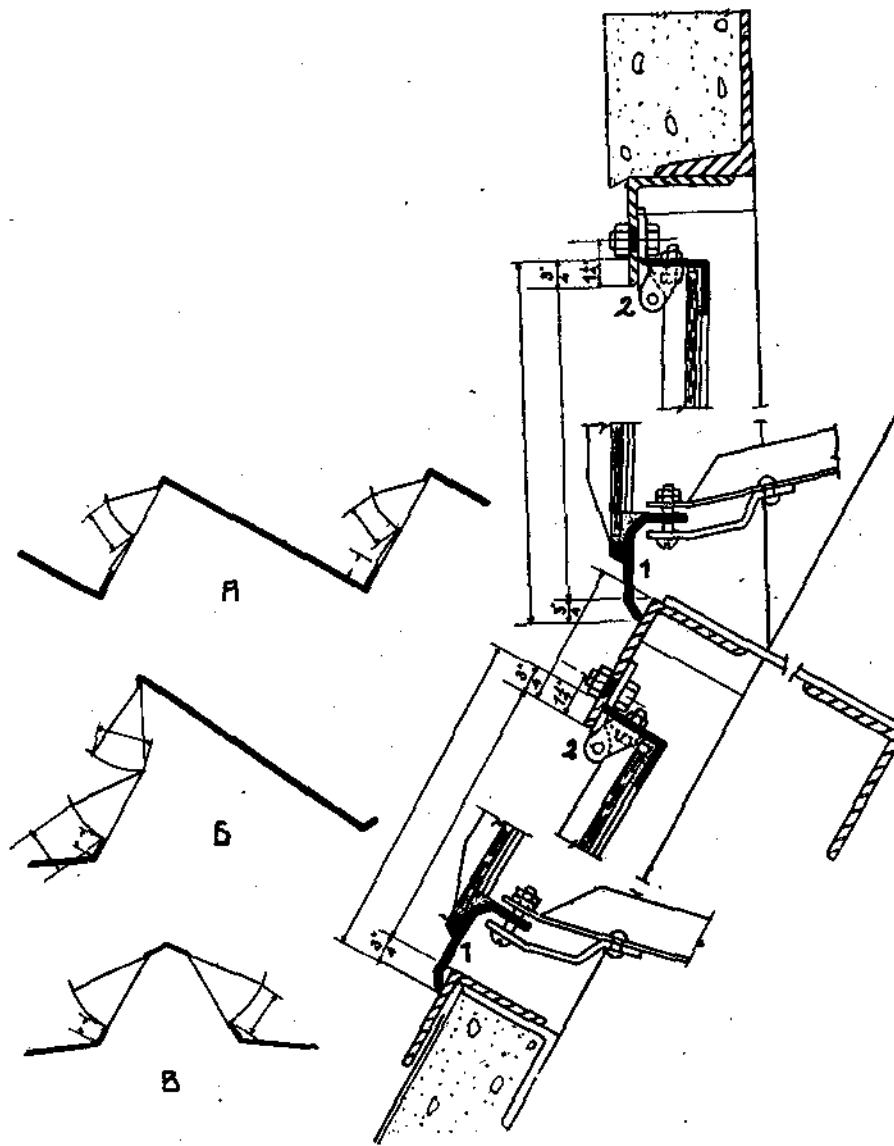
Устройство шарнира в верхней кромке открывающегося полотнища.
